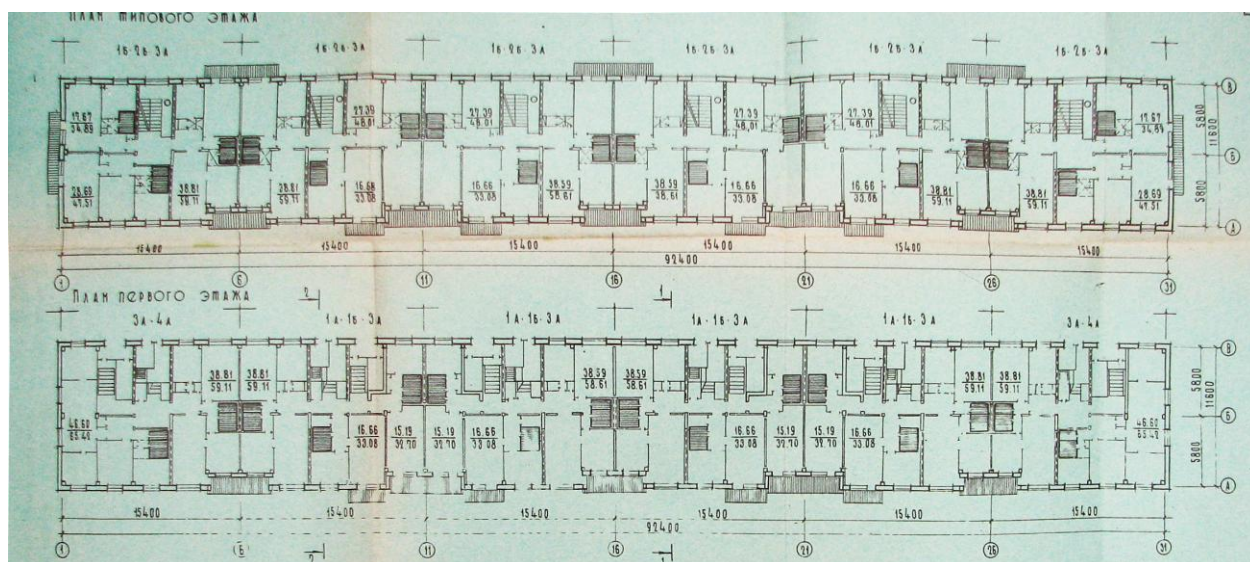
Планы первого и типового этажей жилого дома серии 111-142
